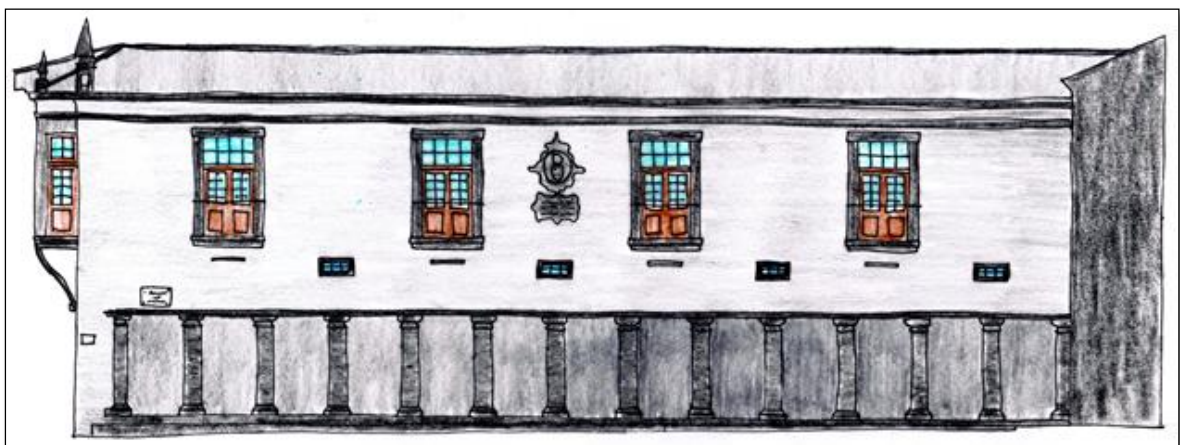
Fachada localizada a Oeste do LP. (Desenho do autor)
